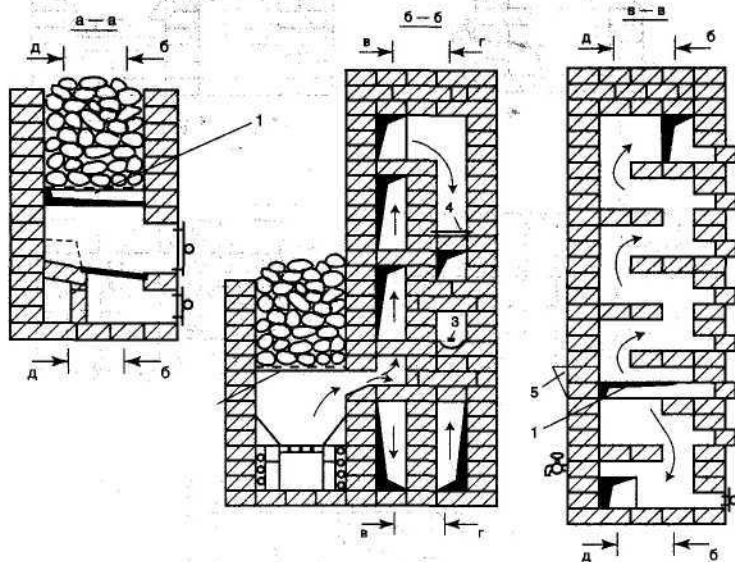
Разрезы и порядовки открытой каменки А. И. Рязанкина: 1 — толстый стальной или чугунный лист; 2 — бак с водой (виден на разрезе д-д, с. 45); 3 — задвижка в глубине выемки, имеющей внизу полукруглую выборку; 4 — задвижка; 5 — горловина бака с водой
